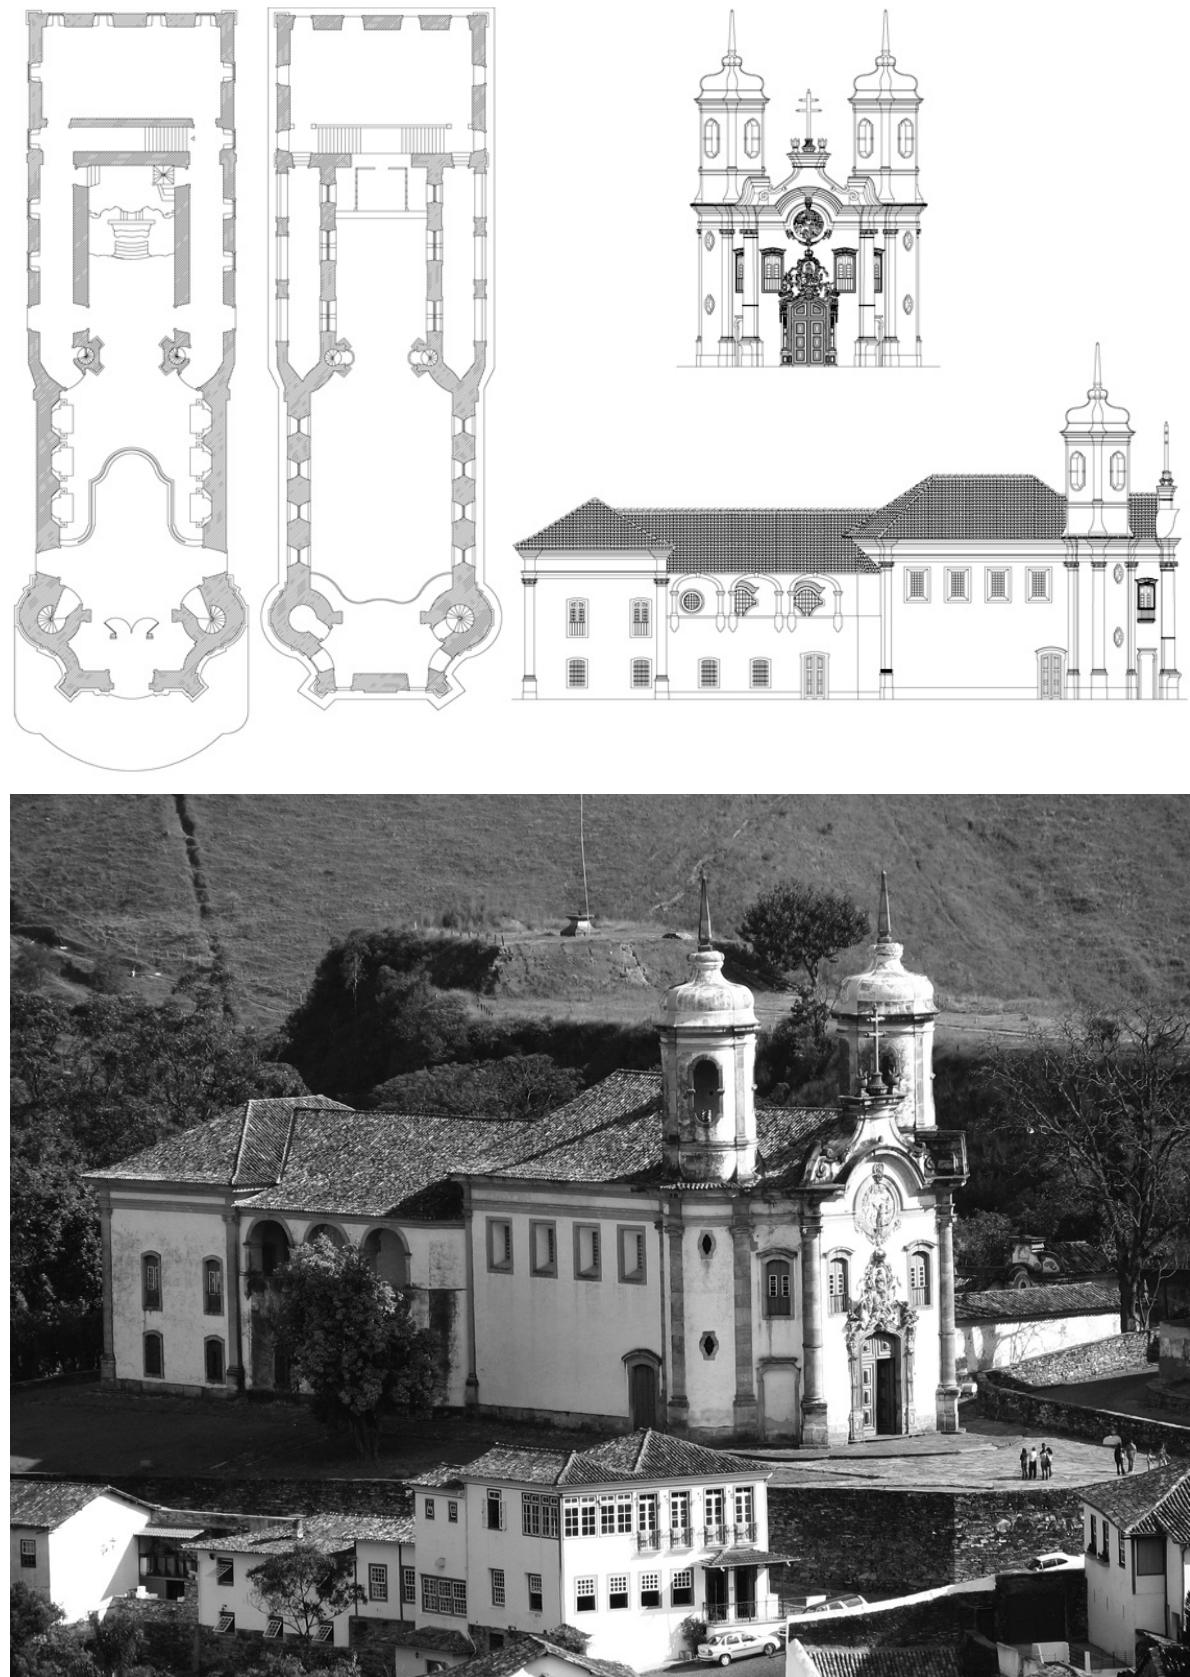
Planta e elevações da Capela de São Francisco de Assis, Vila Rica. Fonte: DANGELO. André. A cultura arquitetônica em Minas Gerais... A vista é foto do autor.
